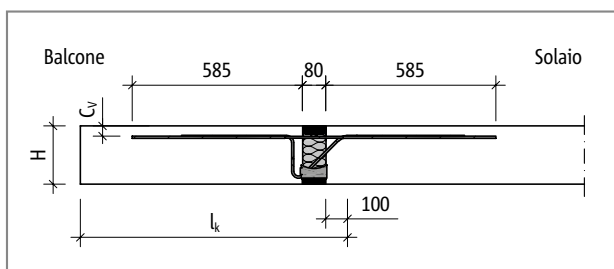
Schöck Isokorb® T tipo KL-M1 - M7: sistema statico
